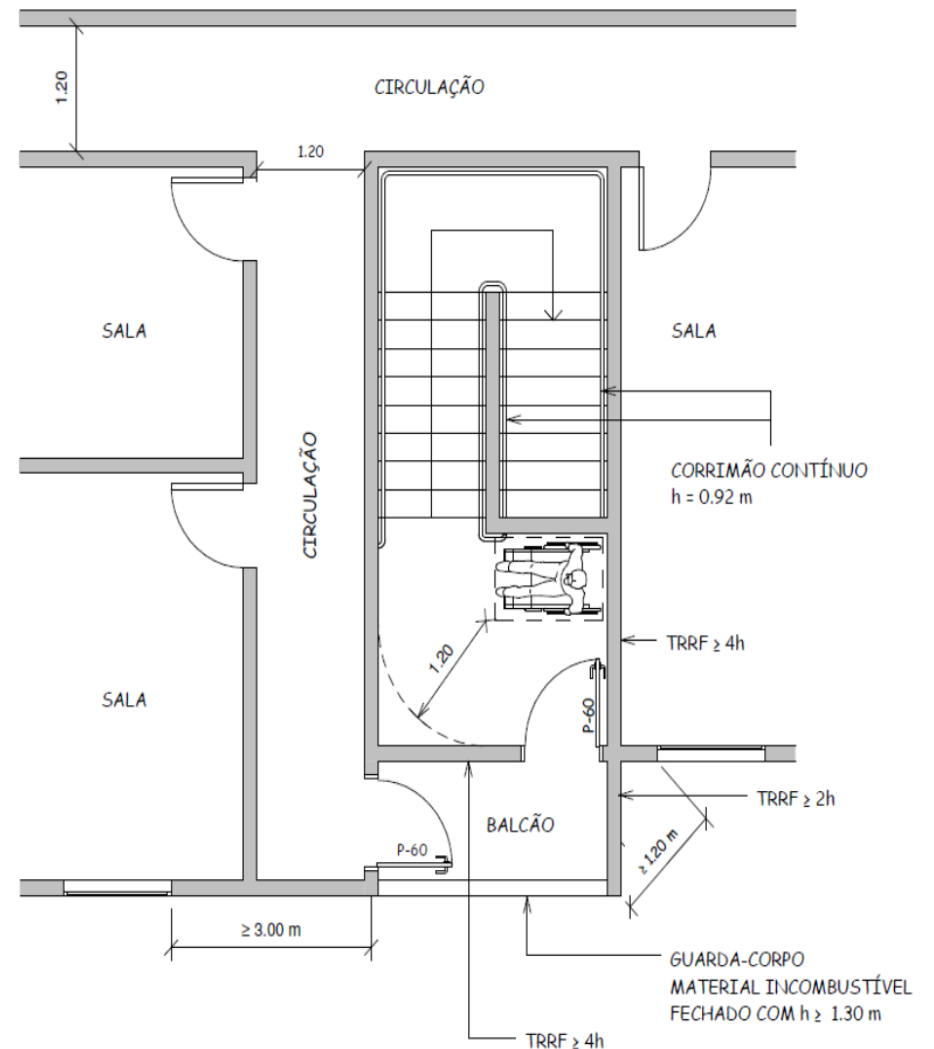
B - Escada à prova de fumaça aberta tipo balcão - pavimento intermediário (planta baixa).
